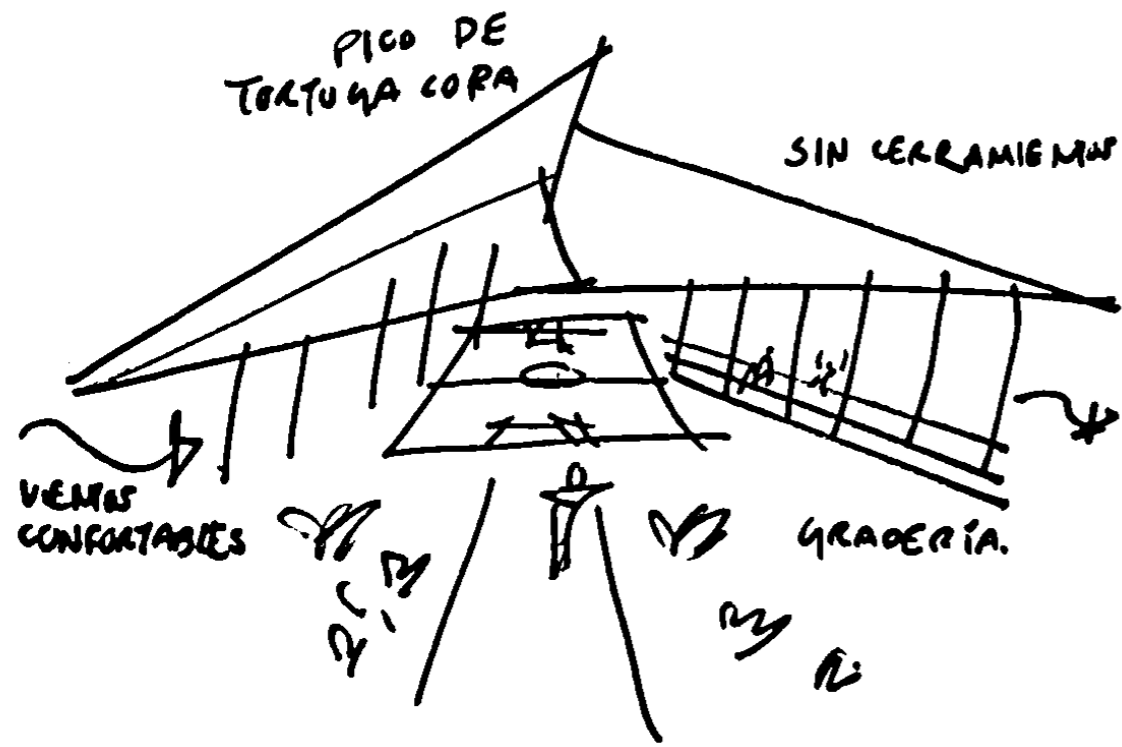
Concepto: reinterpretación de la tortuga lora en el elemento arquitectónico de la cancha
